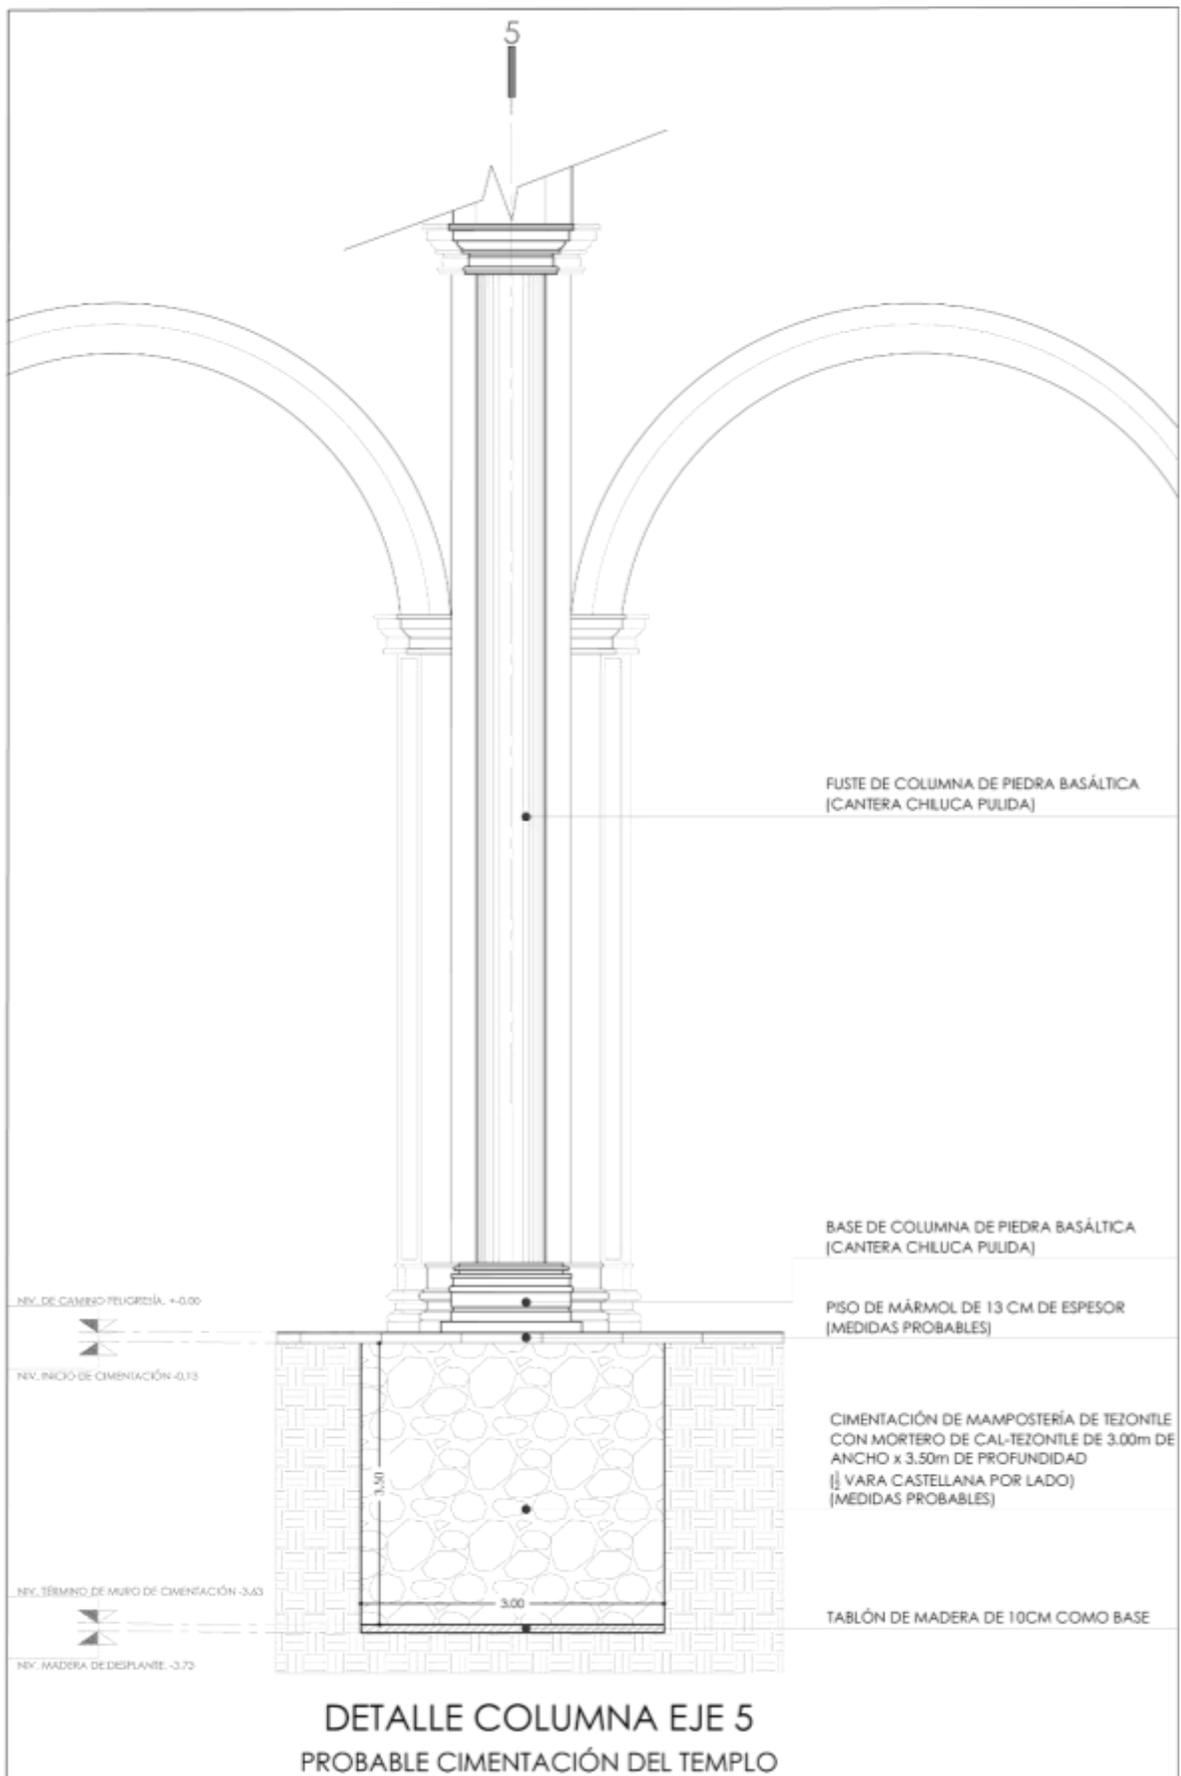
Alzado a detalle de la columna localizada en el eje 5 con cimentación a base de muros perimetrales y contratraves de mampostería.
